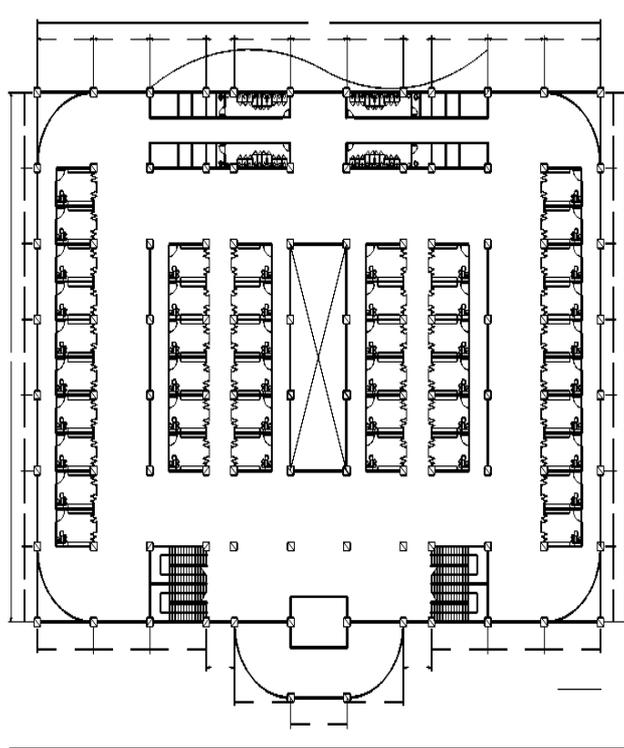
Denah Lantai 1 Hasil *Redesign
